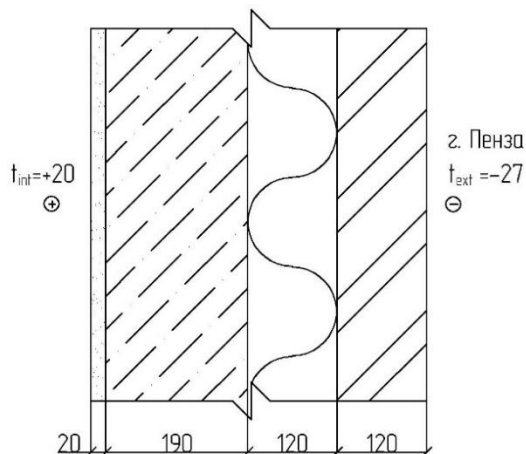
Конструкция утепления стены снаружи с использованием в качестве утеплителя плит из пенополистирола.
